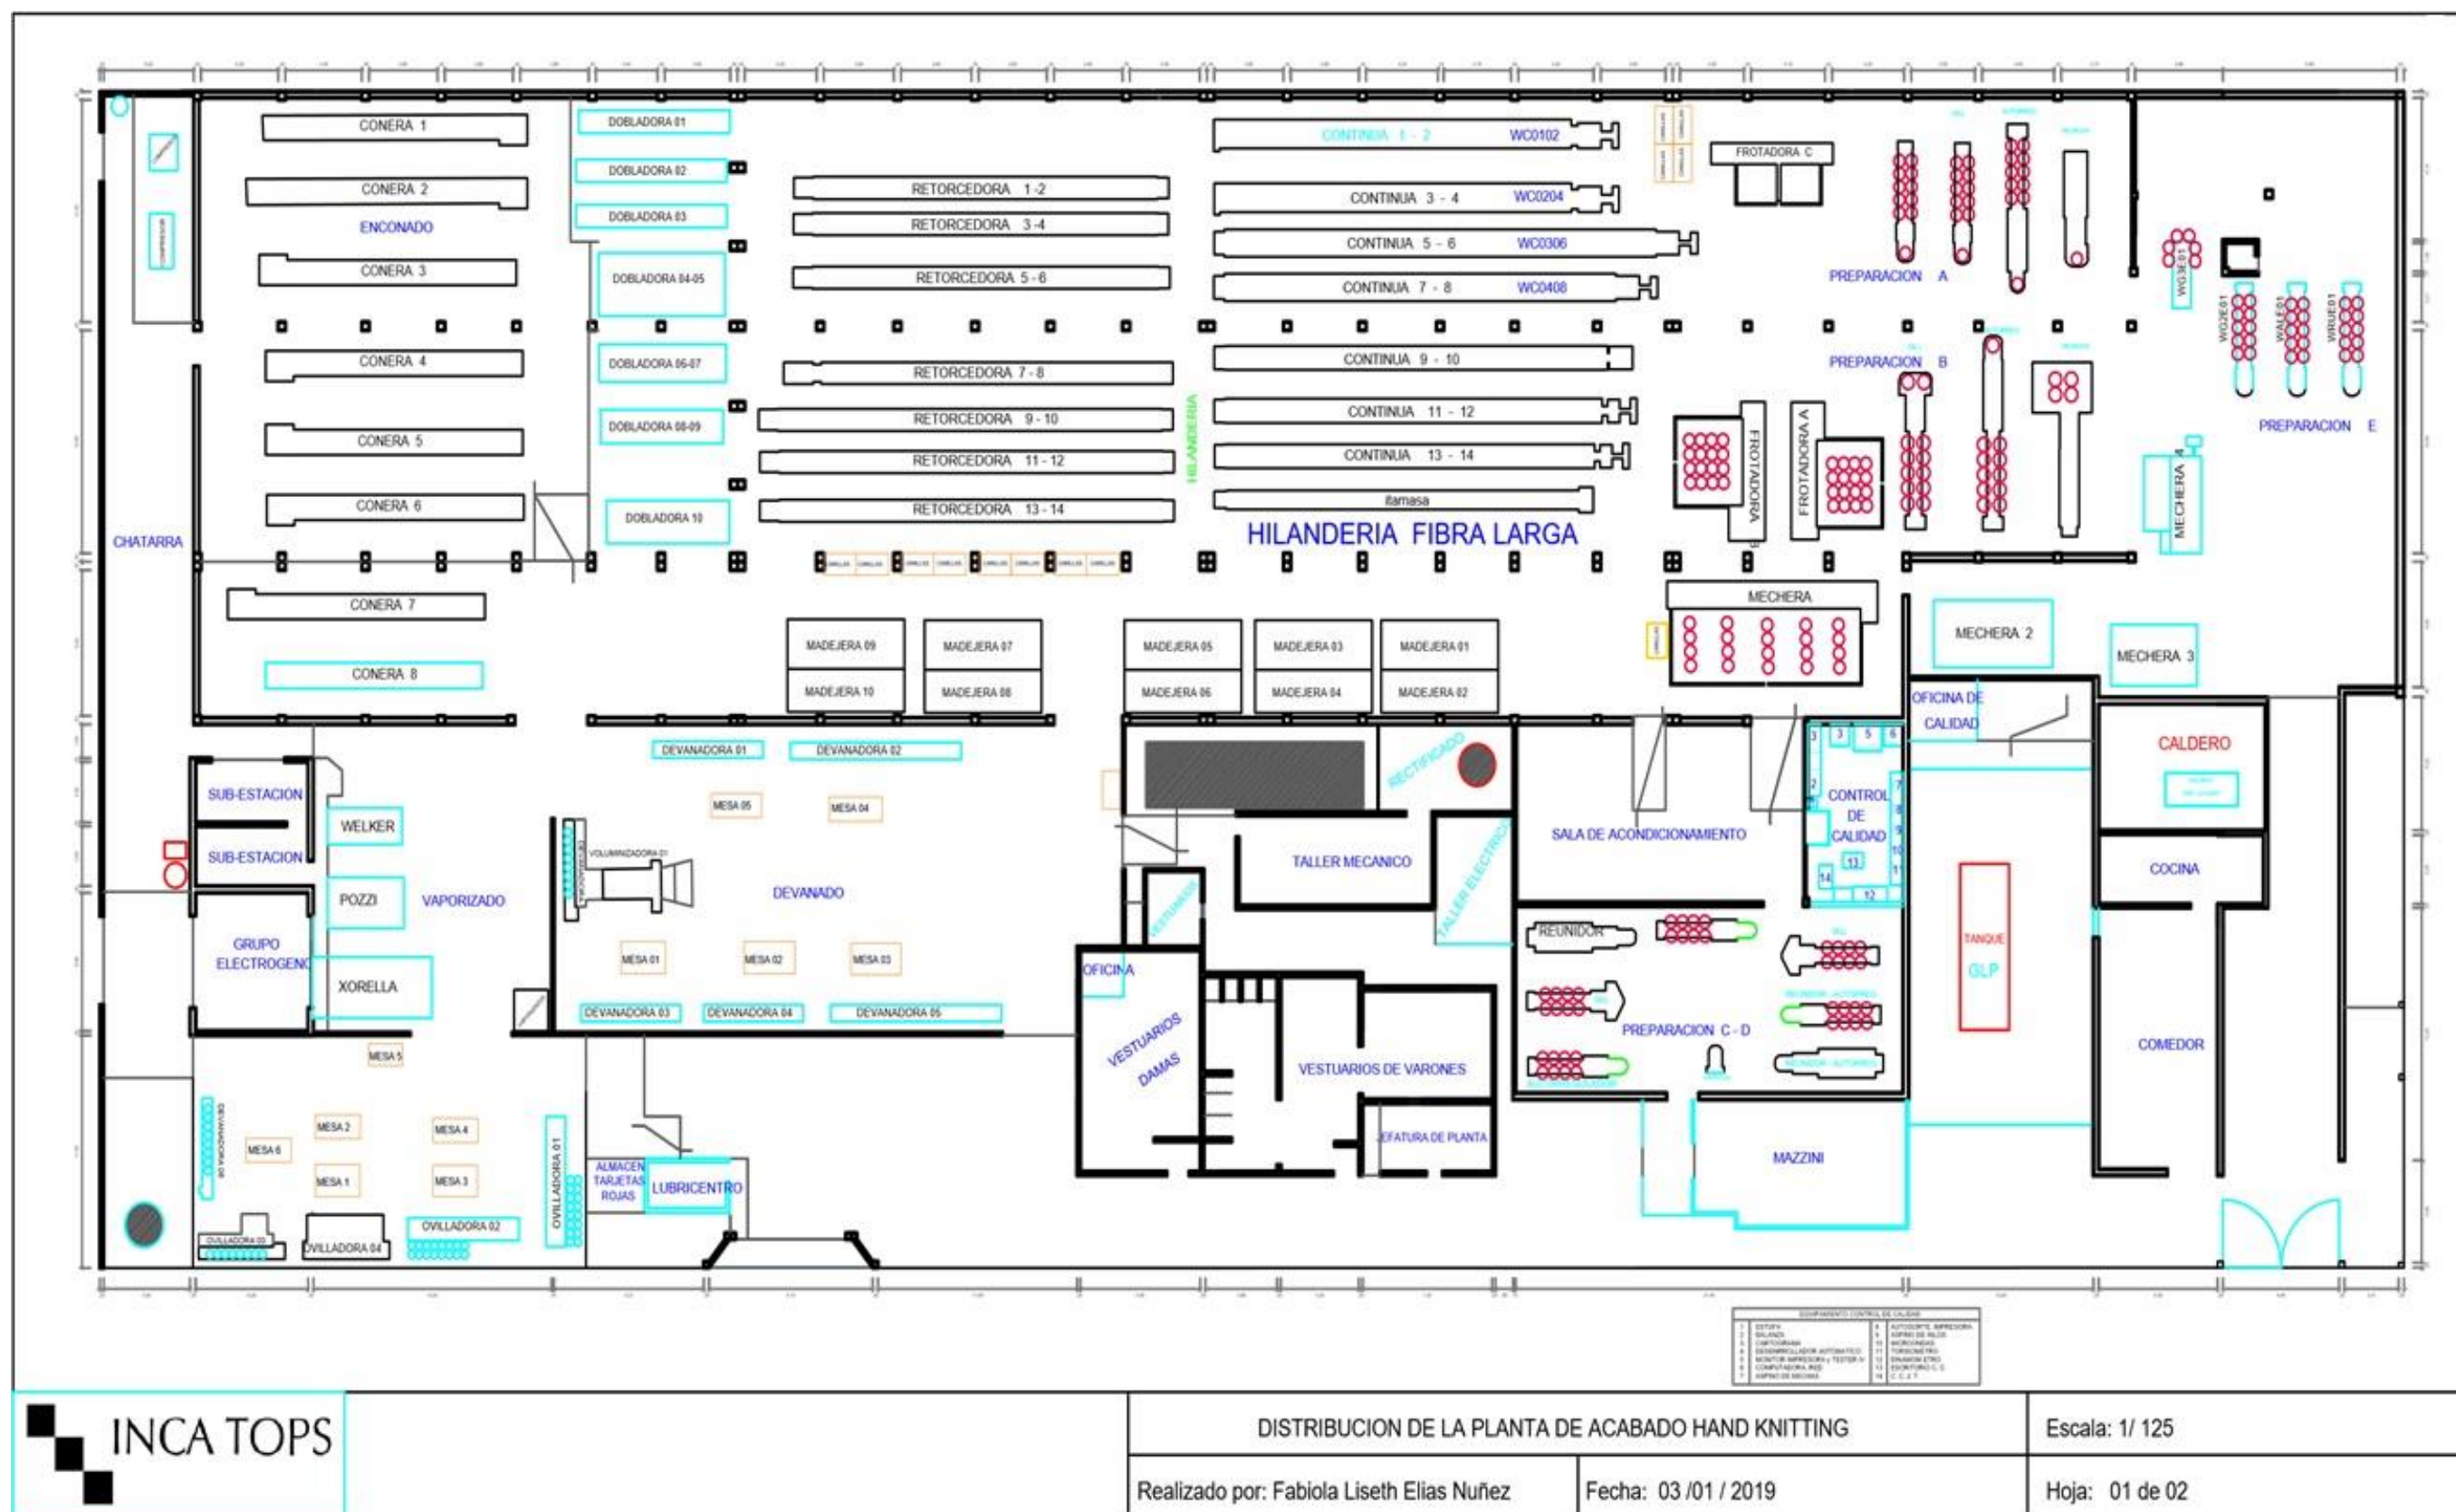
Instalaciones de la planta de Acabados Hand Knitting
